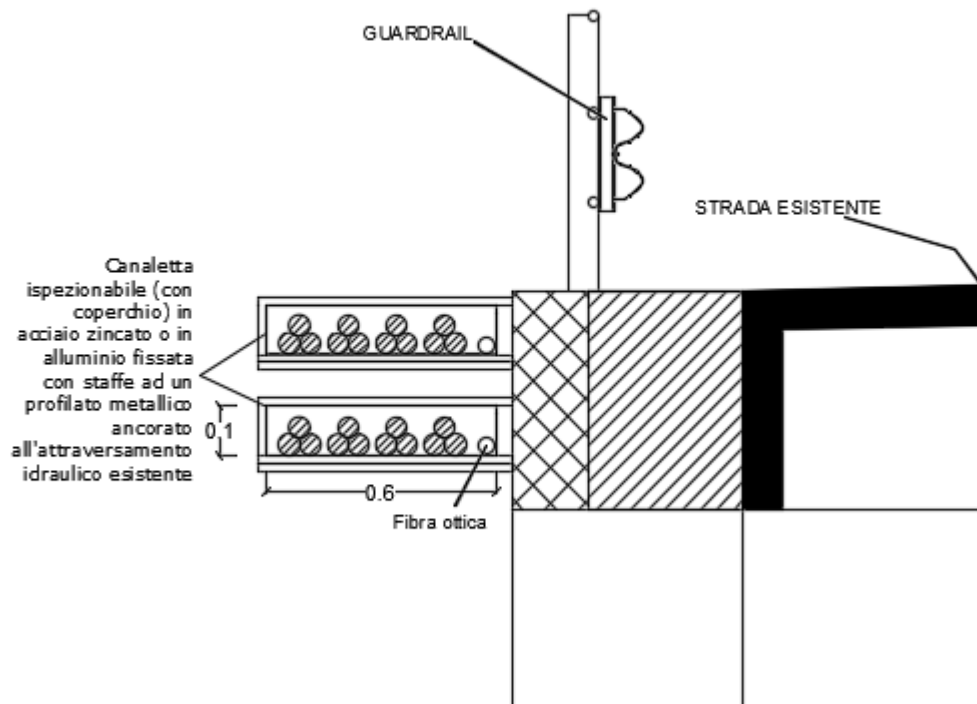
Sezione trasversale cavidotto AT in fiancheggiamento al ponte o cavalcavia.
